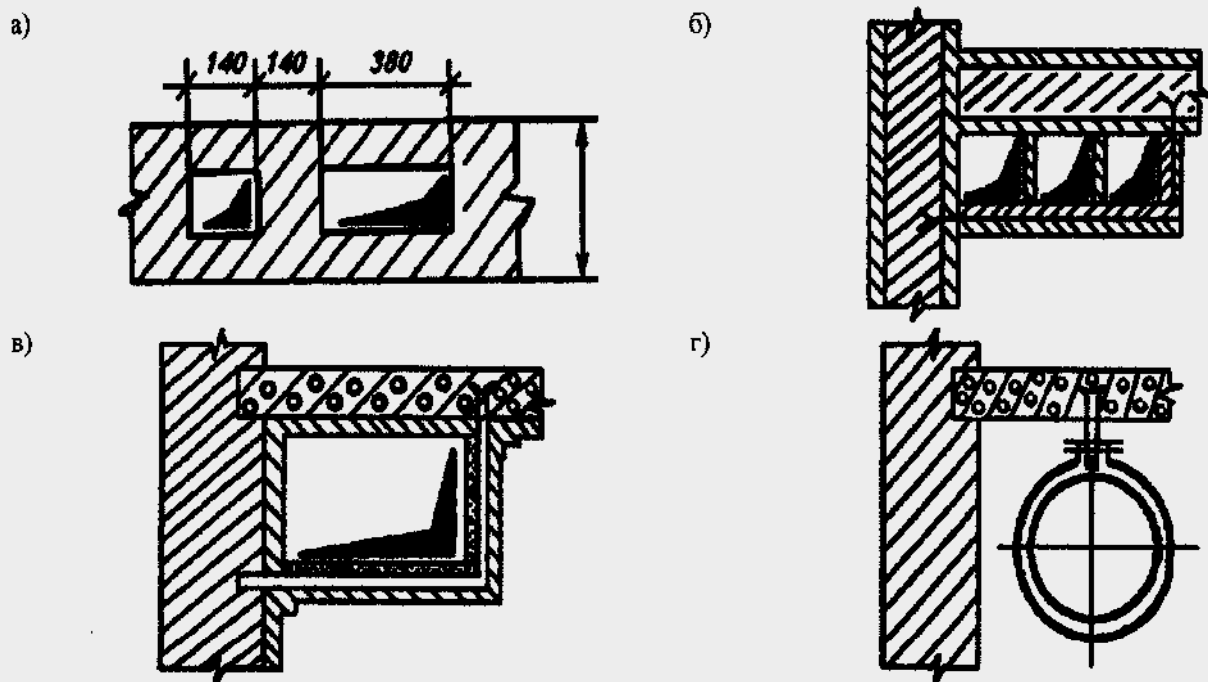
Воздуховоды: канал в стене (а); приставной вертикальный (б); подвесной горизонтальный (в); подвесной круглого сечения (г)
